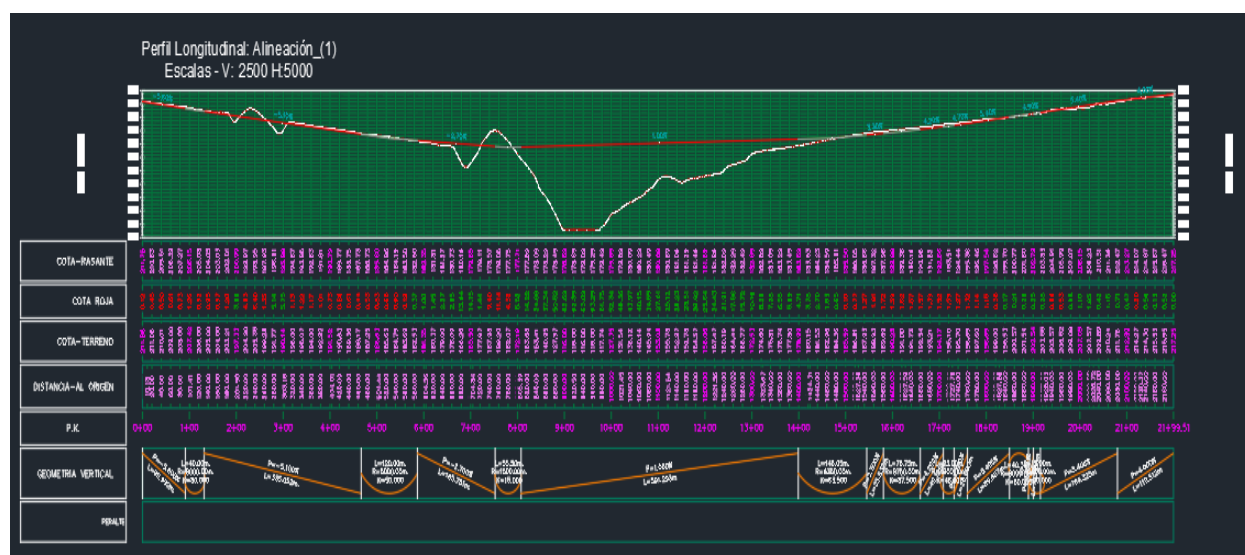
Perfil longitudinal con guitarra en AutoCAD Civil 3D.
